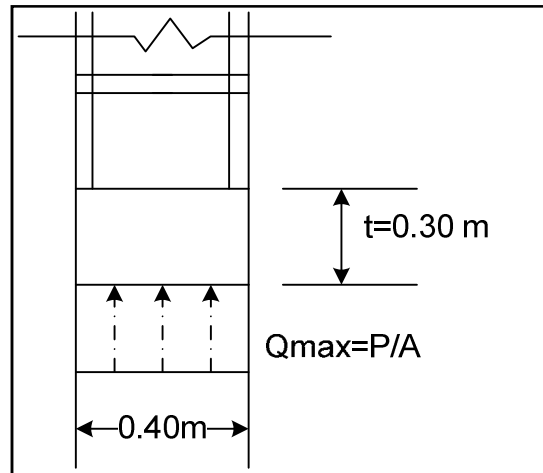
Esquema placa de cimentación muro de mampostería con suelo reforzado
